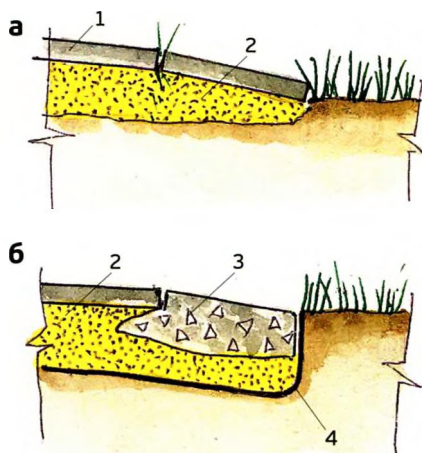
Конструкция примыкания газона к дорожкам, площадкам, пандусам: а — до реконструкции; б — после реконструкции; 1 — бетонные плитки 30 × 30 см; 2 — песчаная подушка; 3 — монолитный бетон М200; 4 — чёрный спанбонд.
